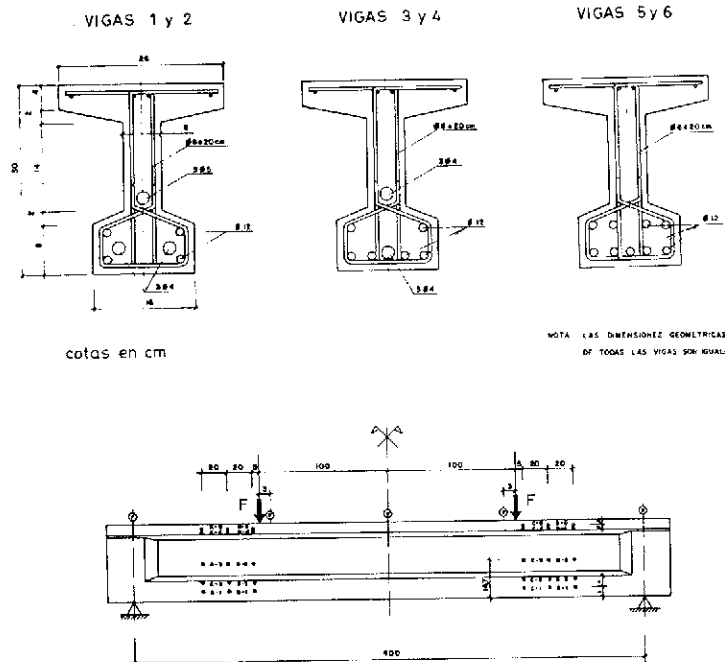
Sección transversal de las vigas y disposición de los ensayos de T. SERRANO (1982).
